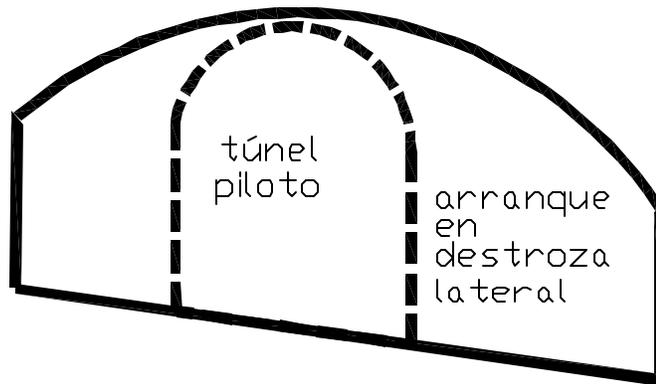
Túnel piloto y barrenos laterales⁽¹⁵⁾
